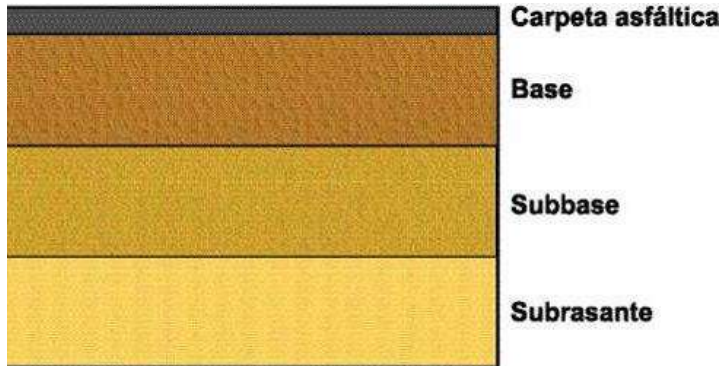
Distribución de cargas en capas de un pavimento flexible. Fuente: www.PECASMAYO.com
